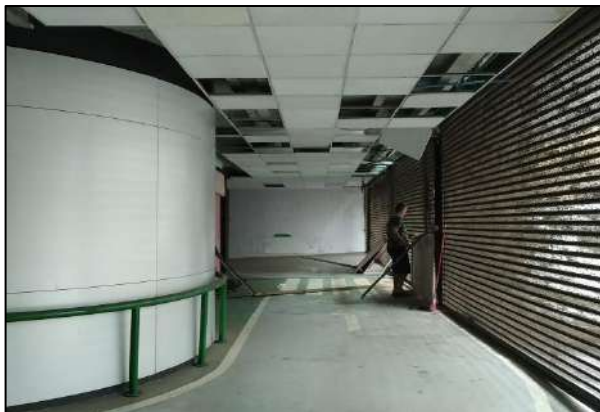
e 10 – Vistoria interna – circulação do pavimento subsolo.
